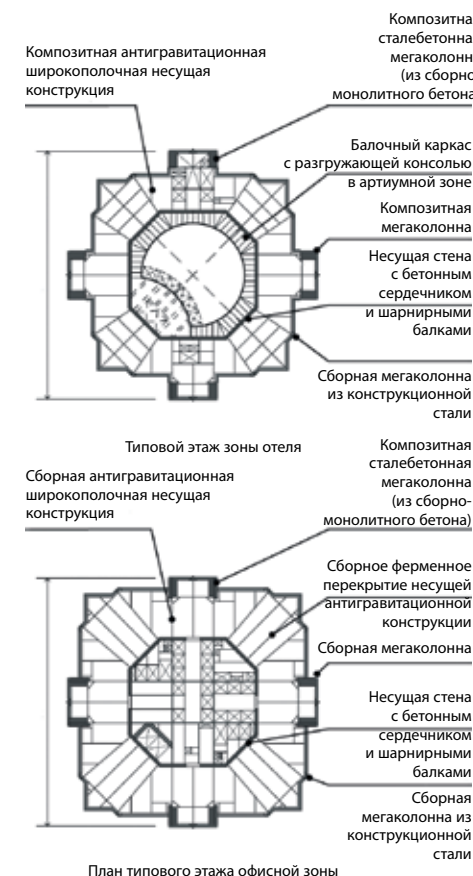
Jin Mao Tower. Схема типового этажа здания (источник: Korista et al., 1995)
